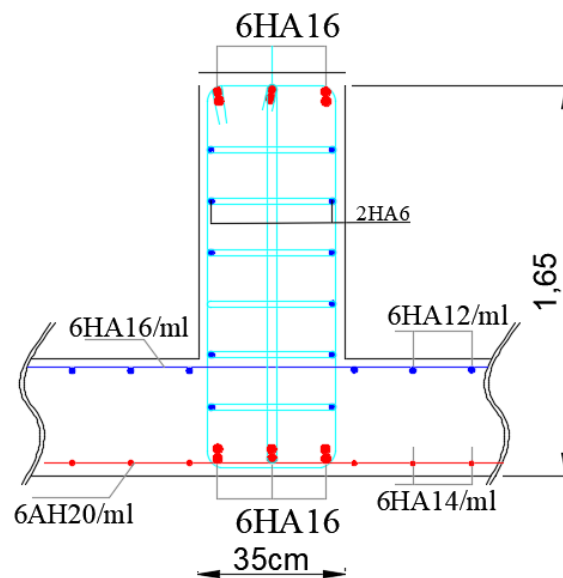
Coupe du ferrailage du radier nervuré.
